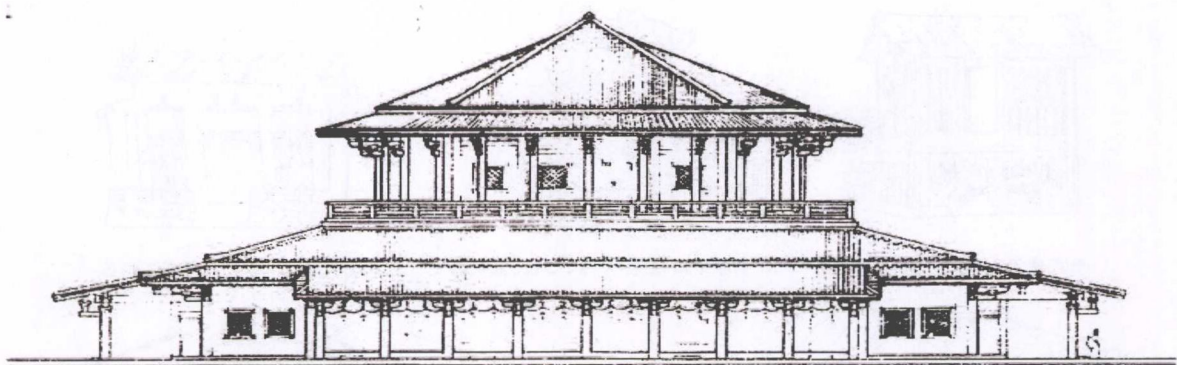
汉长安南郊明堂辟雍复原首层立面图
